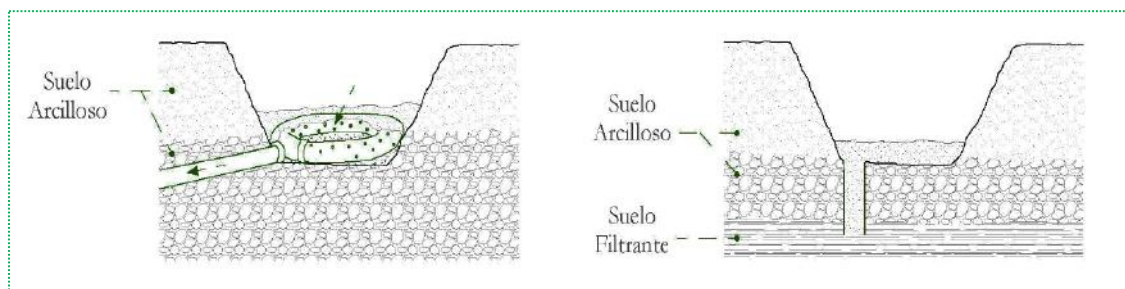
Sistemas de drenaje en hoyos de plantación
